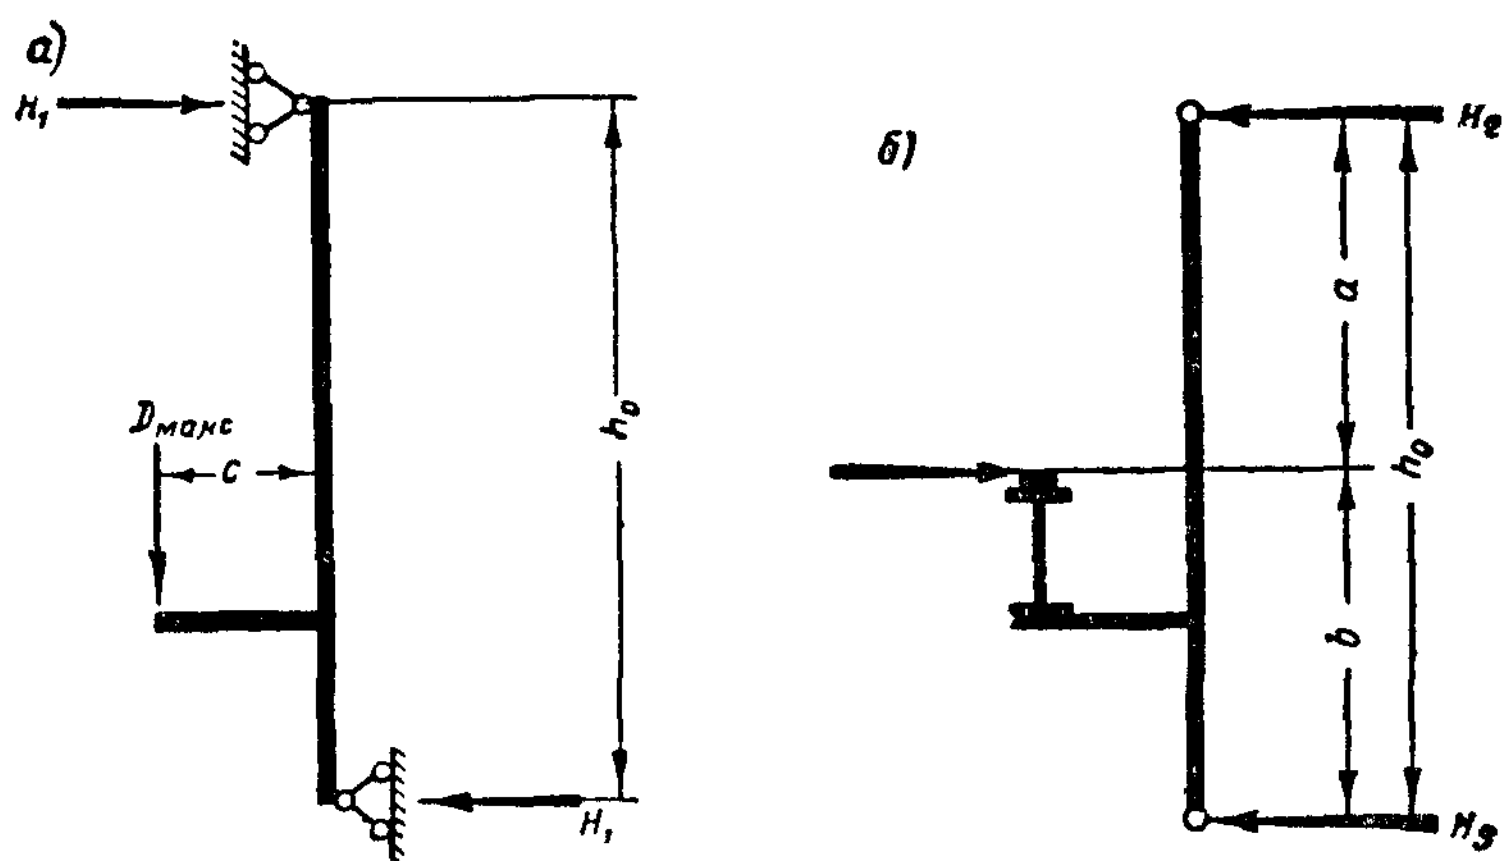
К расчету подкрановой балки с ездой понизу
